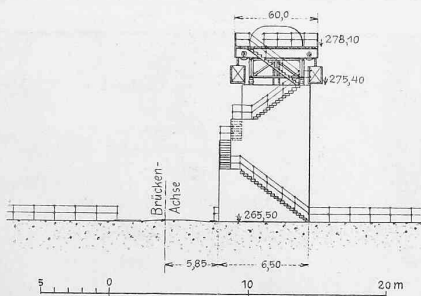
Ansicht des linksseitigen Landpfeilers.
